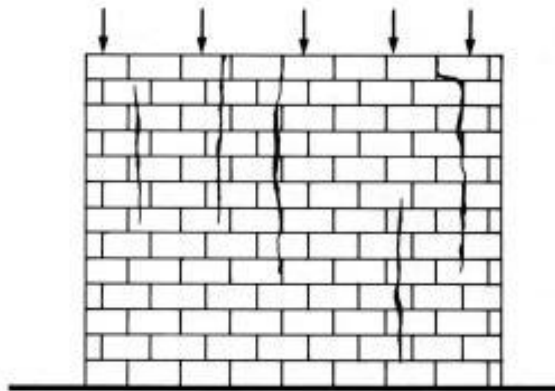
Fissuras verticais por sobrecarga. (Fonte: <http://www.ebah.com.br>)
